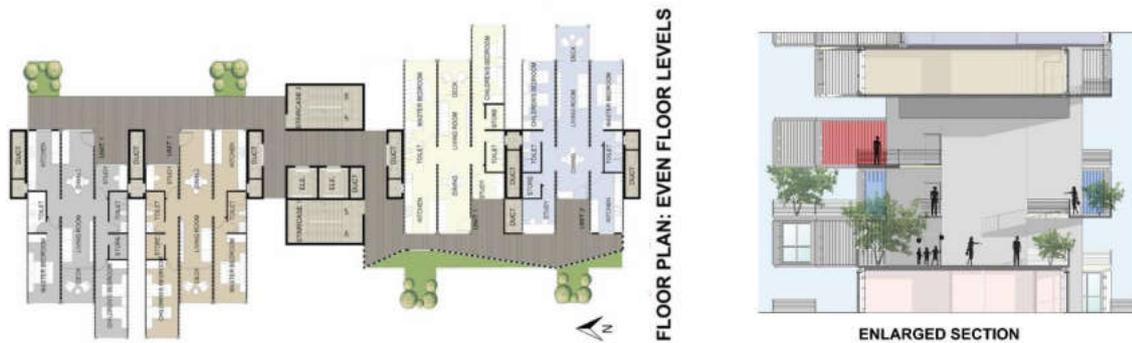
e 26: Planta tipo dos apartamentos e corte. Fonte: ArchDaily, 2015.
